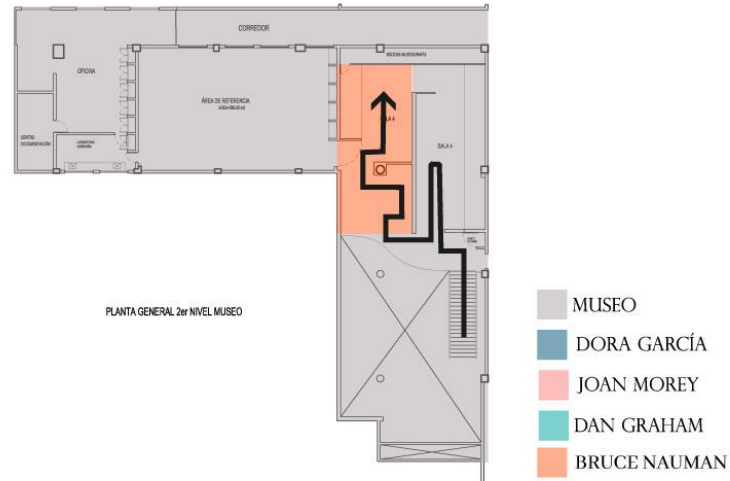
Planos del Museo de Ciencias Naturales de la Salle, plan de recorrido segundo nivel. Intervenido por Bryan Restrepo.
